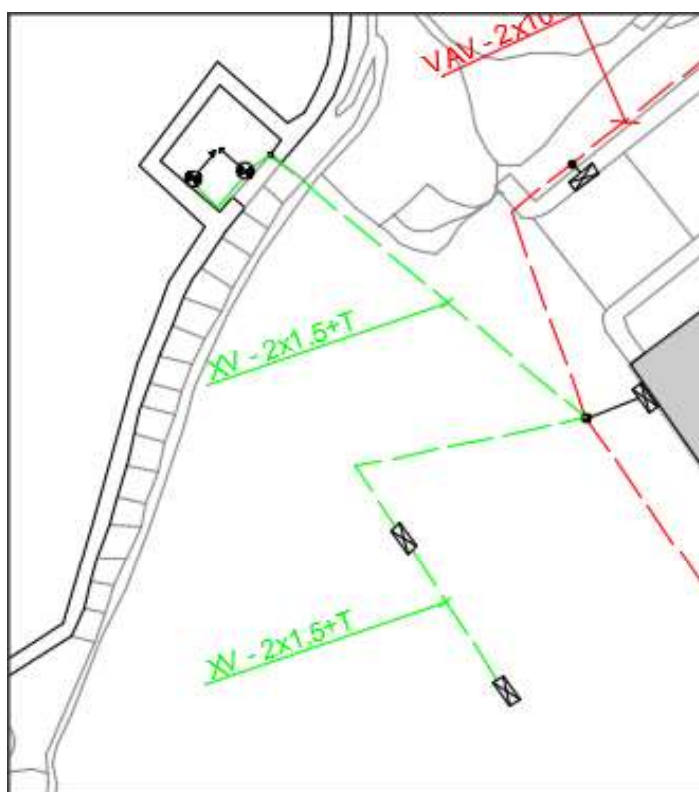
Ilustração das canalizações do ramal dos Caminhos de Circulação, Porta da Traição e jardim paroquial (Autocad 2016)
